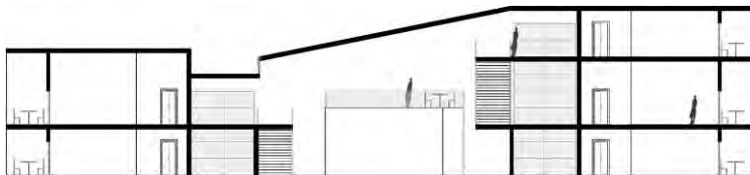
Desenho corte longitudinal, hotel de duas estrelas. (Ilustração nossa, 2011)
